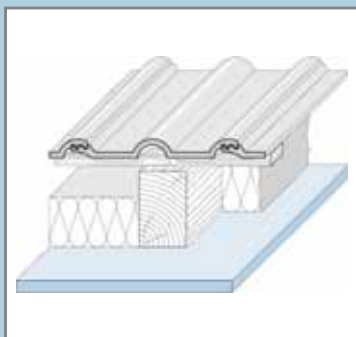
Изоляция гипсоволокнистой обшивки мансарды в случае бескаркасной схемы ее крепления
